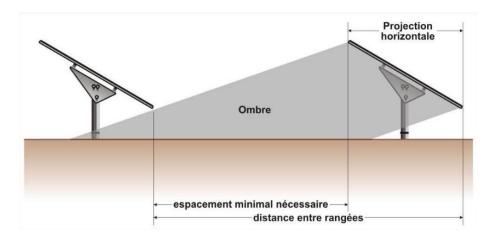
Schéma de principe pour l'installation des panneaux et des tables d'assemblage
